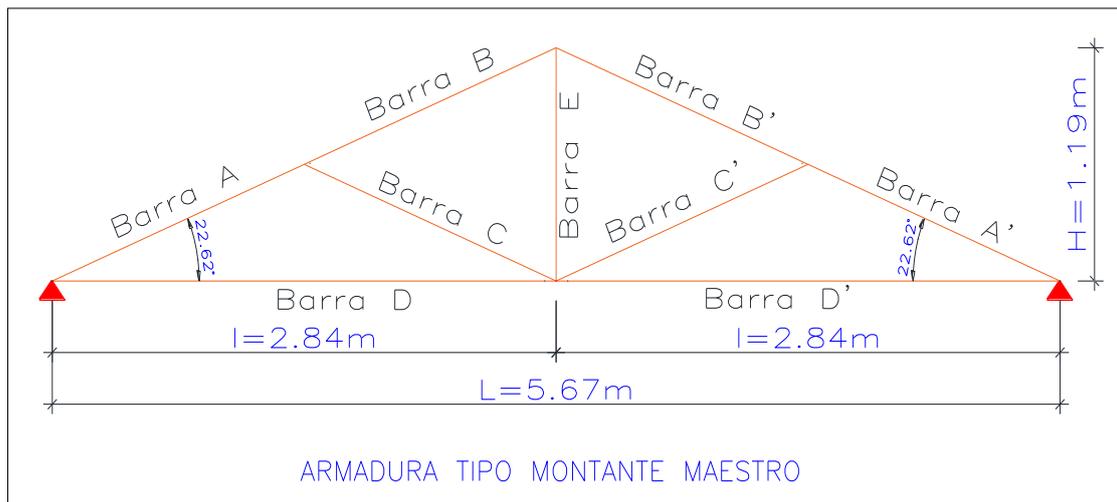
Distribución de barras de la armadura tipo montante maestro
